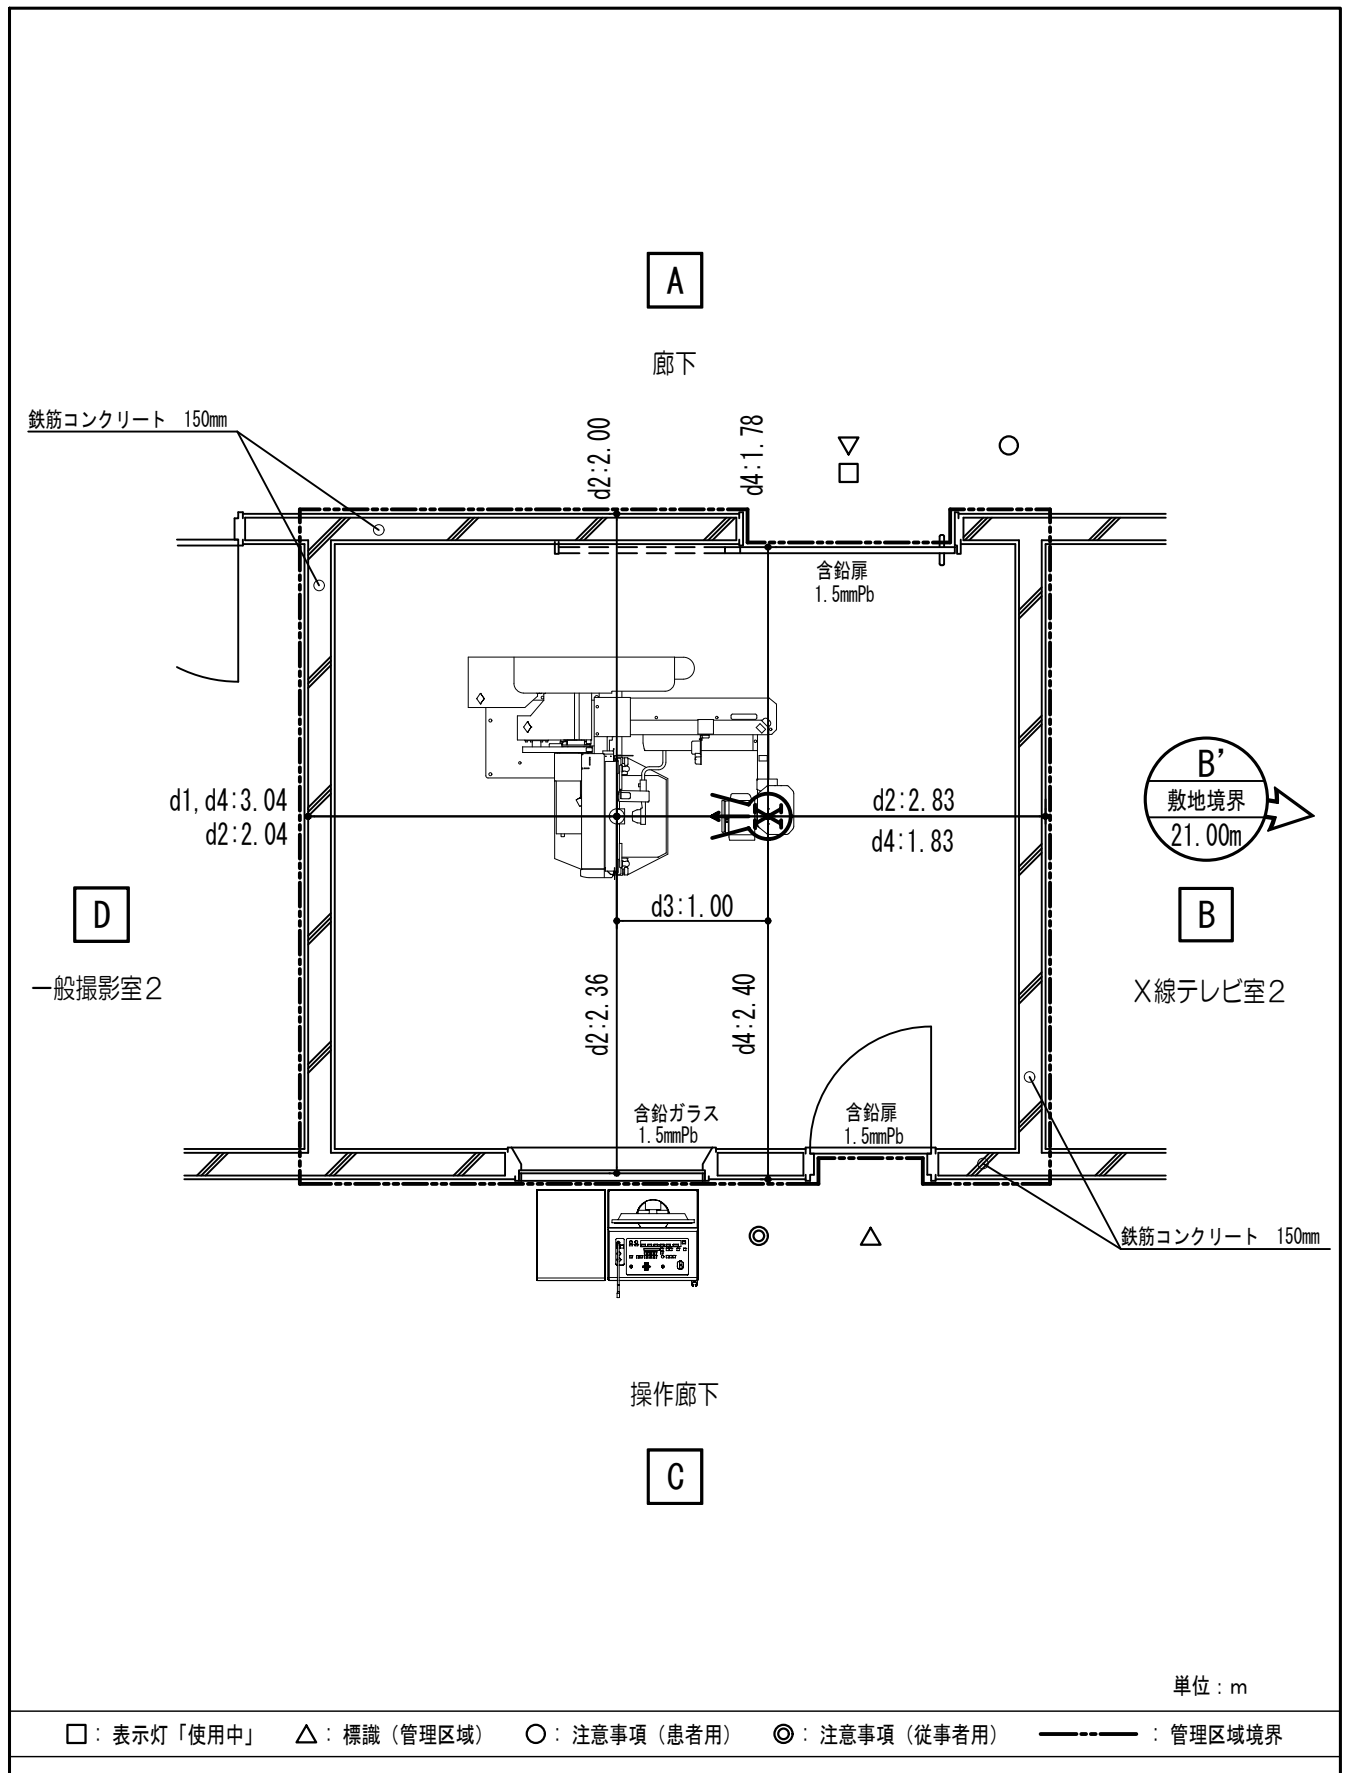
X線テレビ室 立位 透視・撮影 平面図
